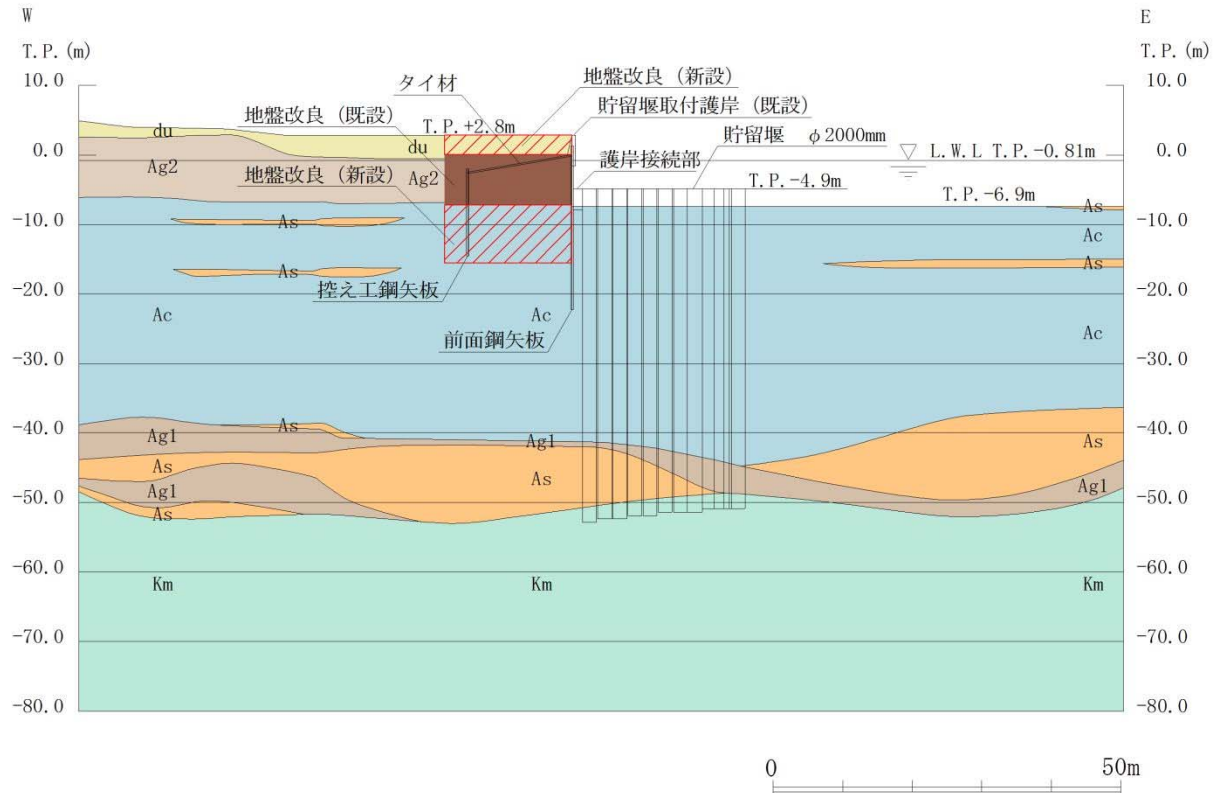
(2) 貯留堰の縦断断面図 (B-B 断面)
